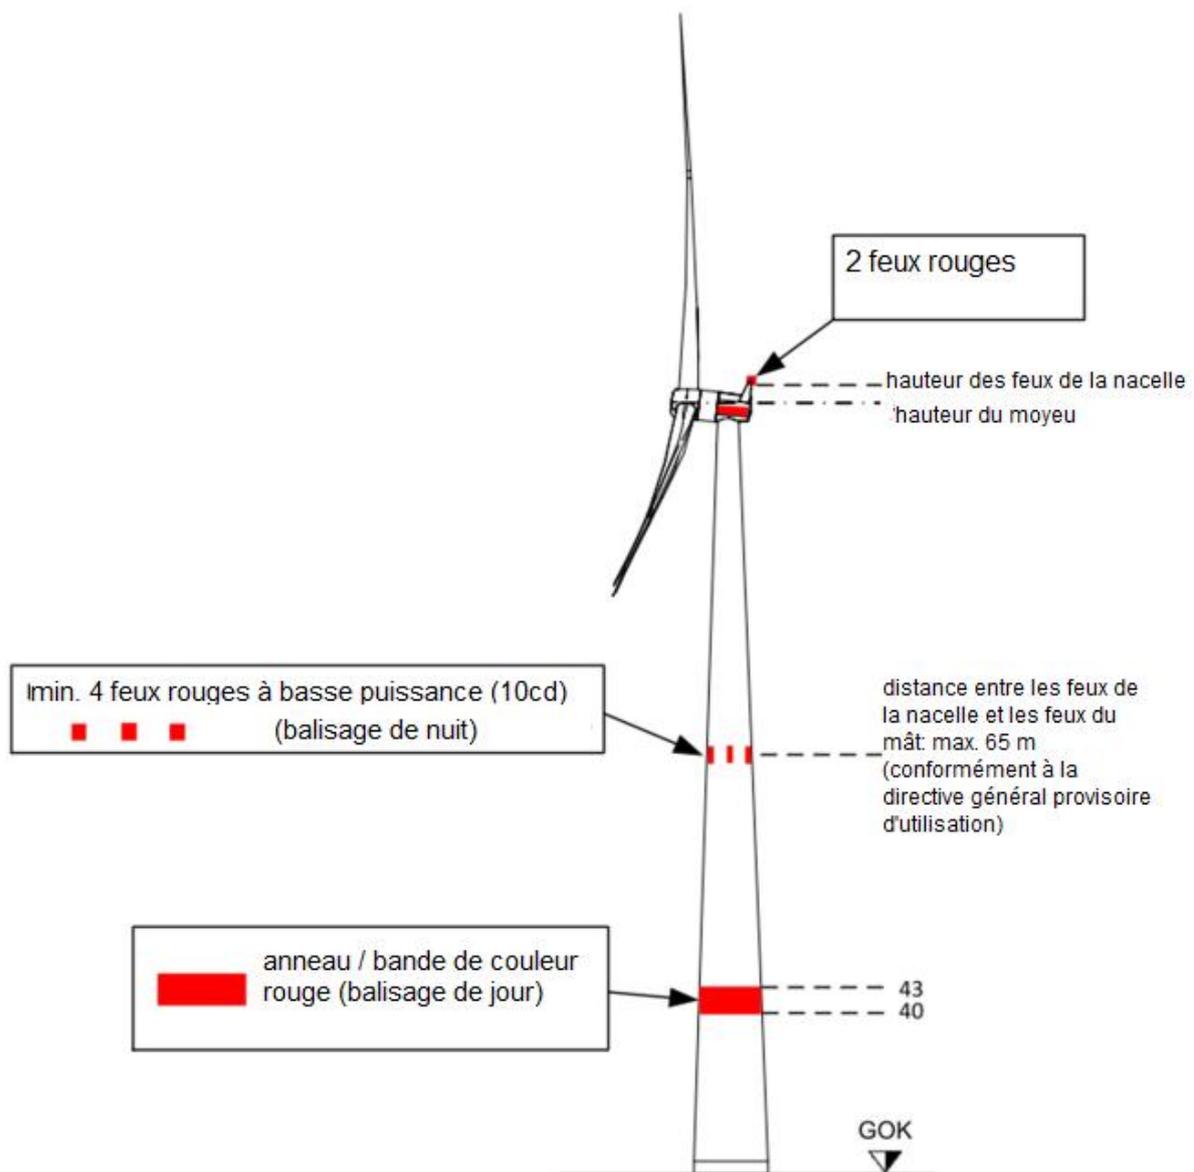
115 & 135 m de hauteur de moyeu, vue latérale
